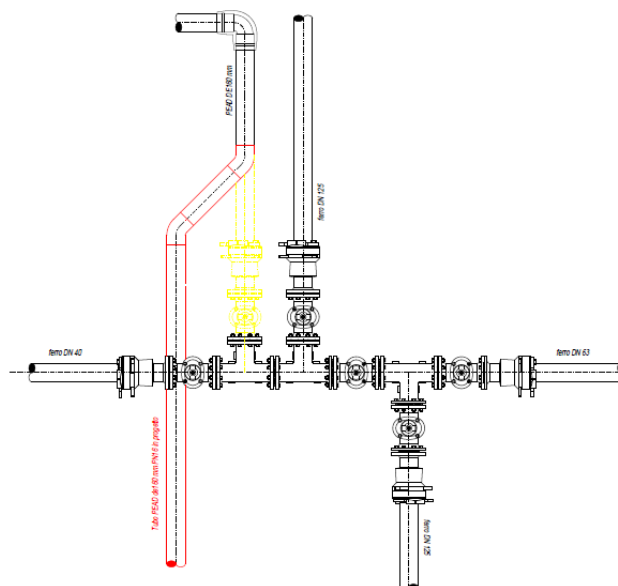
Sdoppiamento uscita dal Pozzo Fontane e collegamento alla rete del distretto “Verbanella”.
